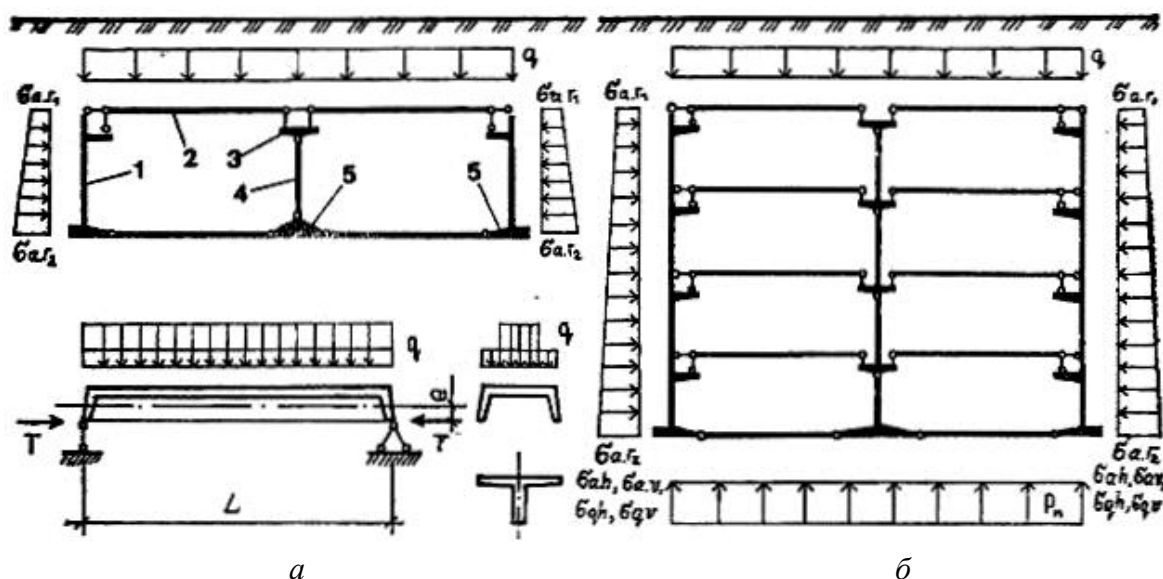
Розрахункові схеми будівель, що зводяться відкритим способом:
